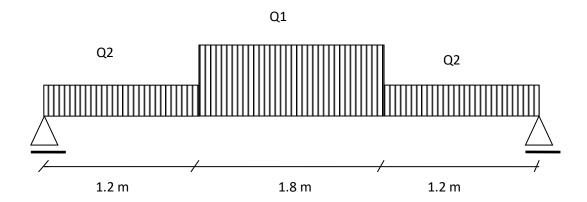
schéma statique d'un escalier a paillasse avec deux
